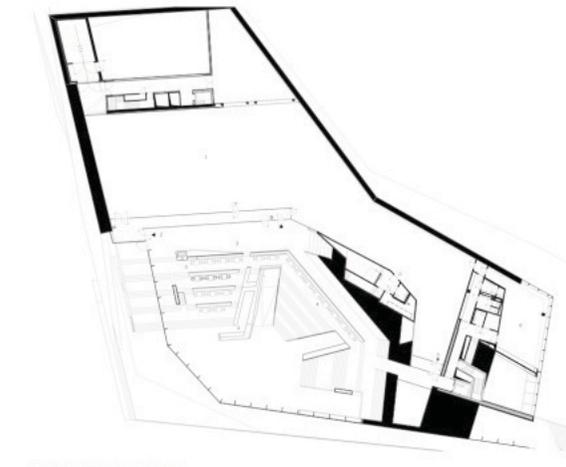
Grundrisse, Filmmuseum Amsterdam
